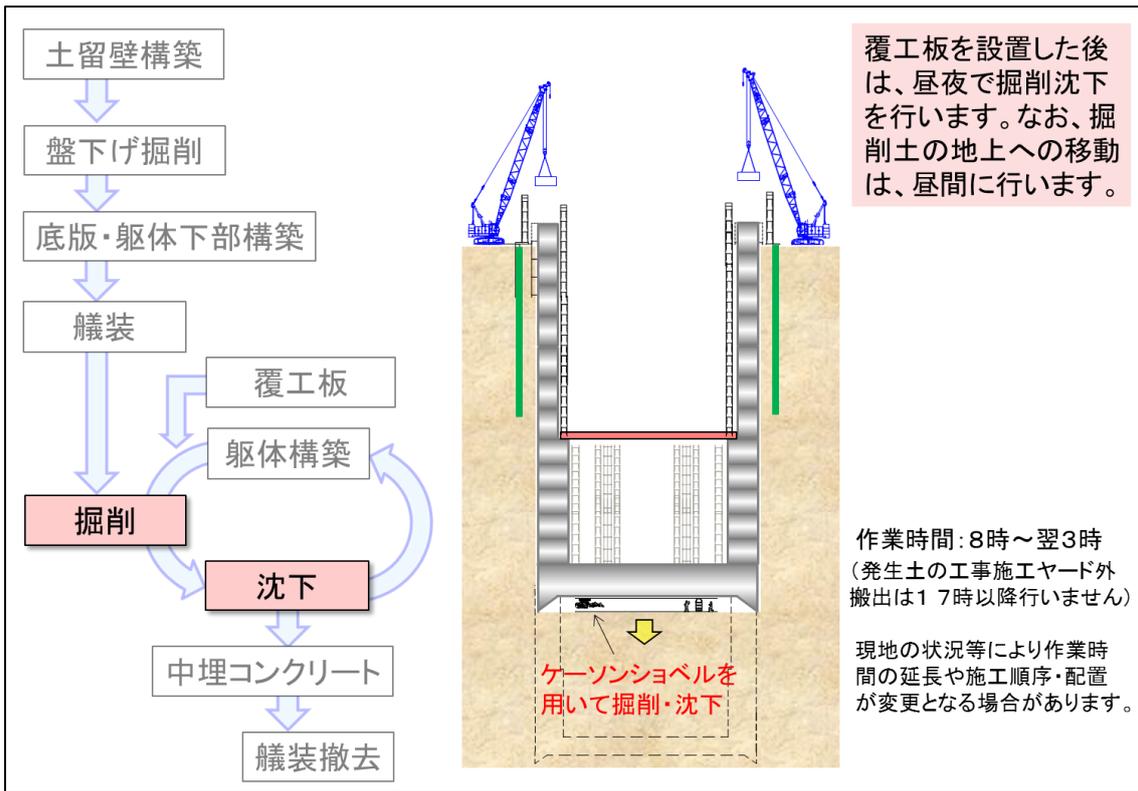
(11) ニューマチックケーソン工（掘削・沈下）の施工手順
